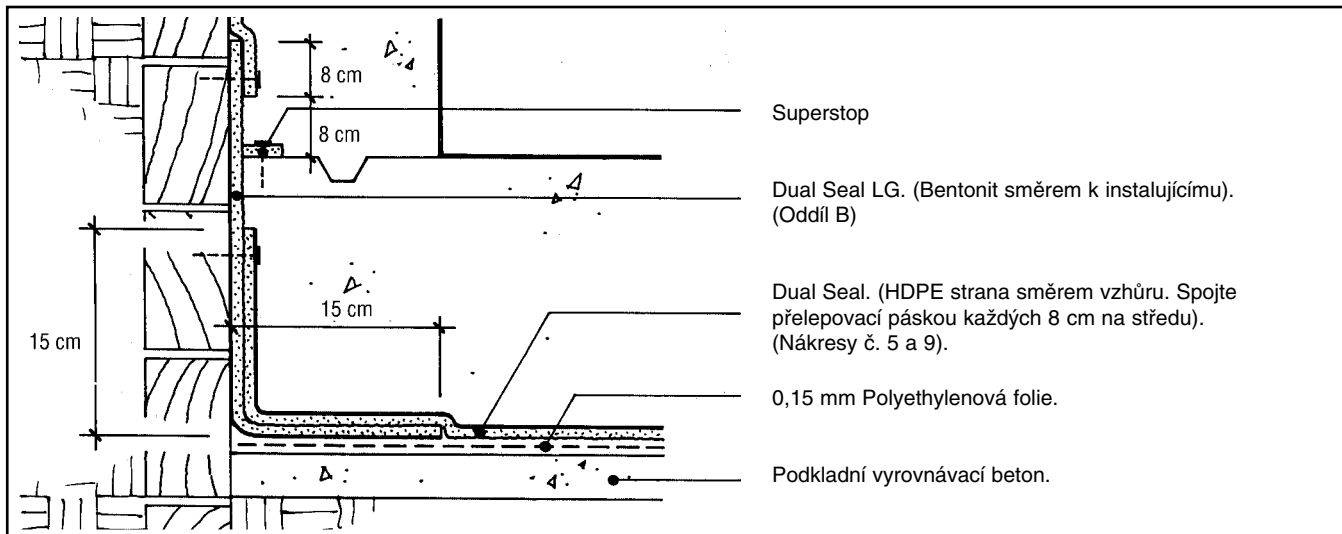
Spojení nechráněné zdi/podkladní vrstvy a podlahy.
